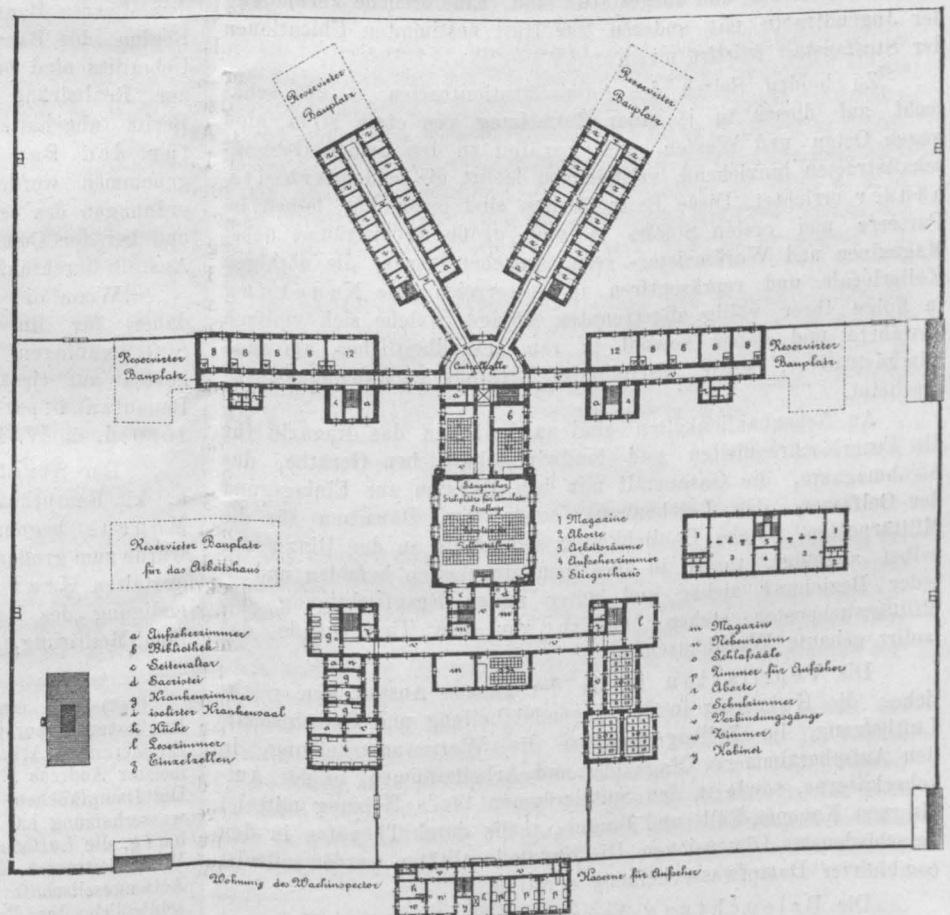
Grundriss des ersten Stockwerkes.
